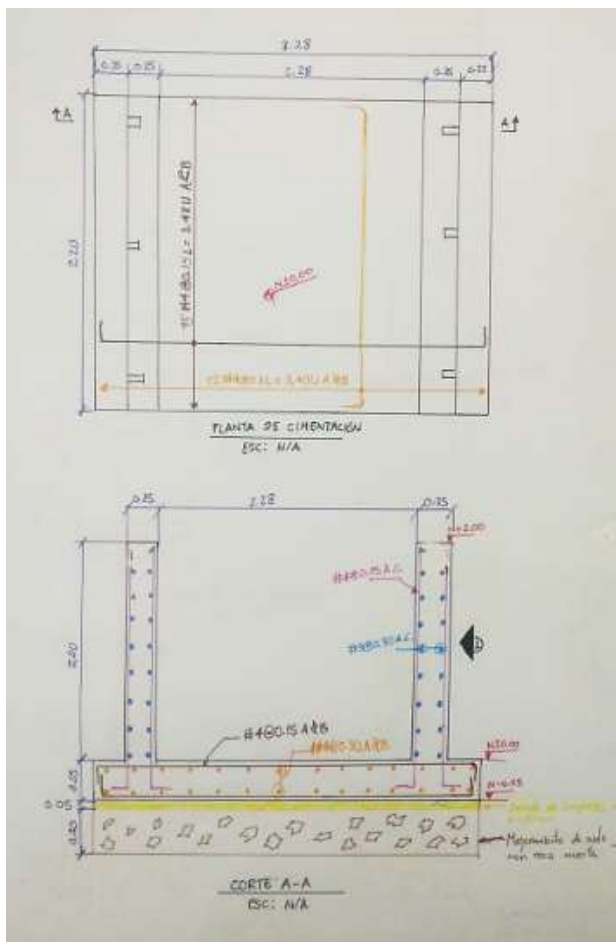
Planos piernas de aspiración. Fuente. FERVAR INGENIEROS E.U.
